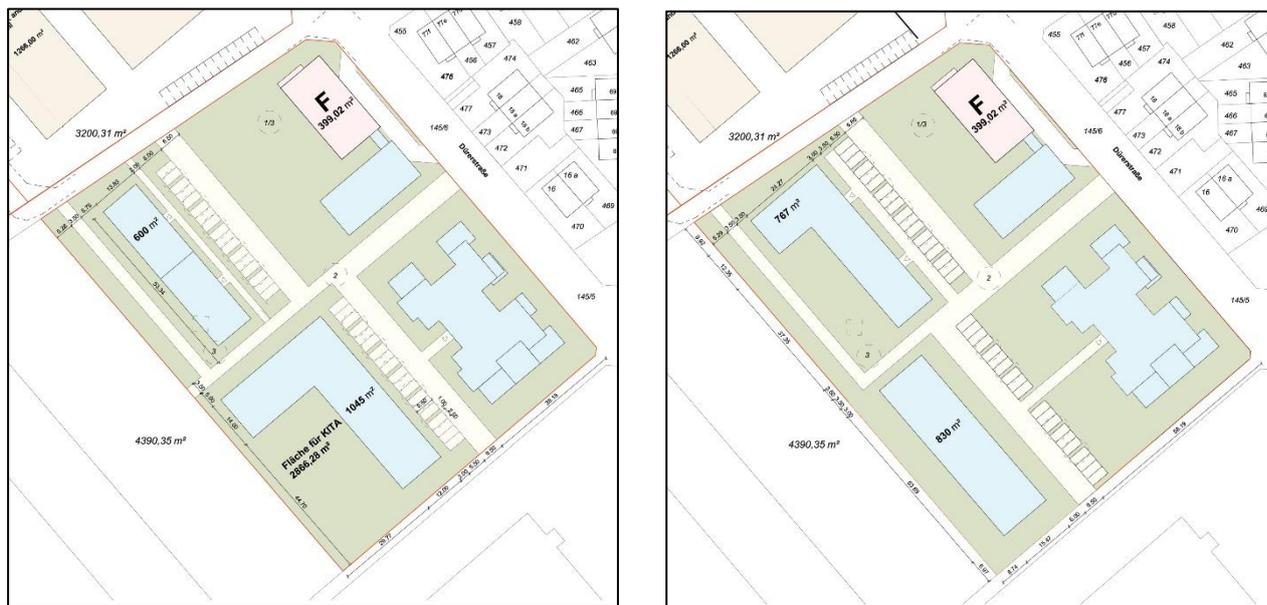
Städtebauliches Konzept Südteil mit Alternative
